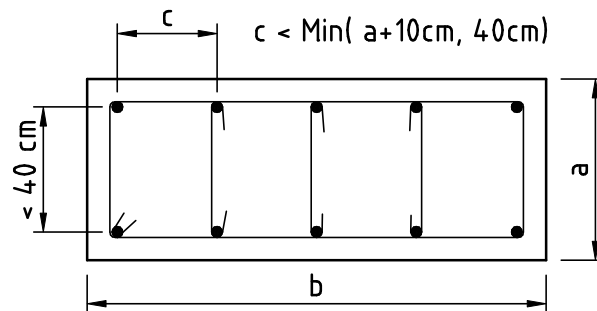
Espacement maximal des armatures longitudinales d'un poteau.
